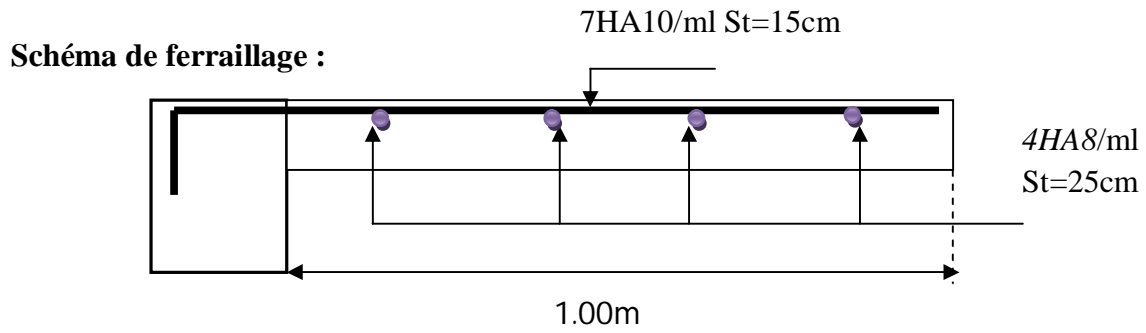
Schéma de ferrailage de 1^{er} type de dalle.
